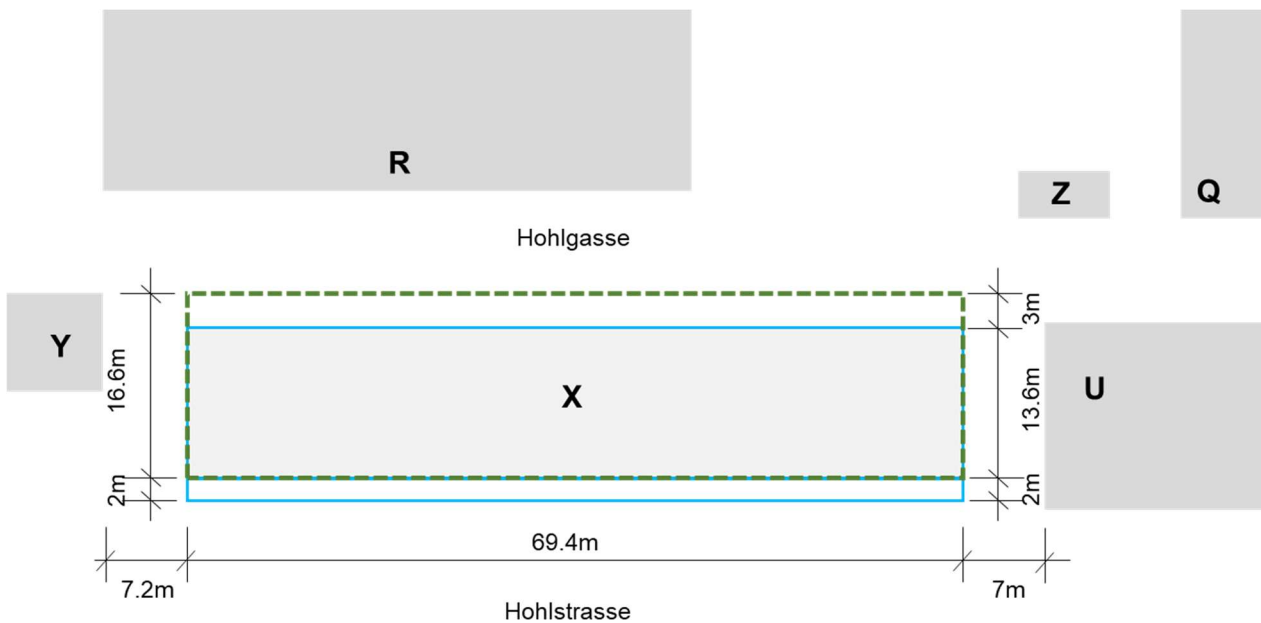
Gebäude X: Gebäudedimensionen (Mantellinie) im Grundriss gemäss Bebauungsregeln Masterplan
